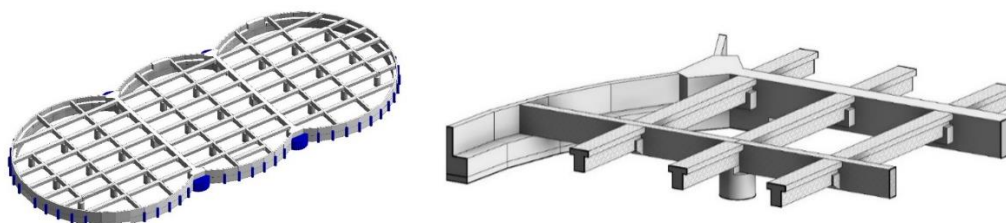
Vista 3D das vigas da cobertura do reservatório.
